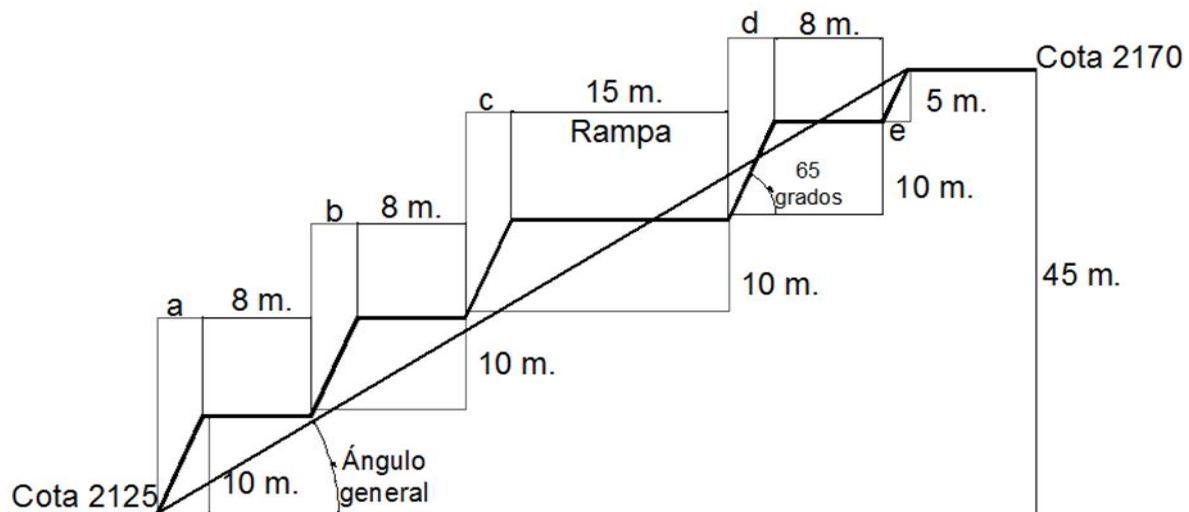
Sección longitudinal, ángulo general de talud, bancos y rampa de acceso de la zona oriente.
